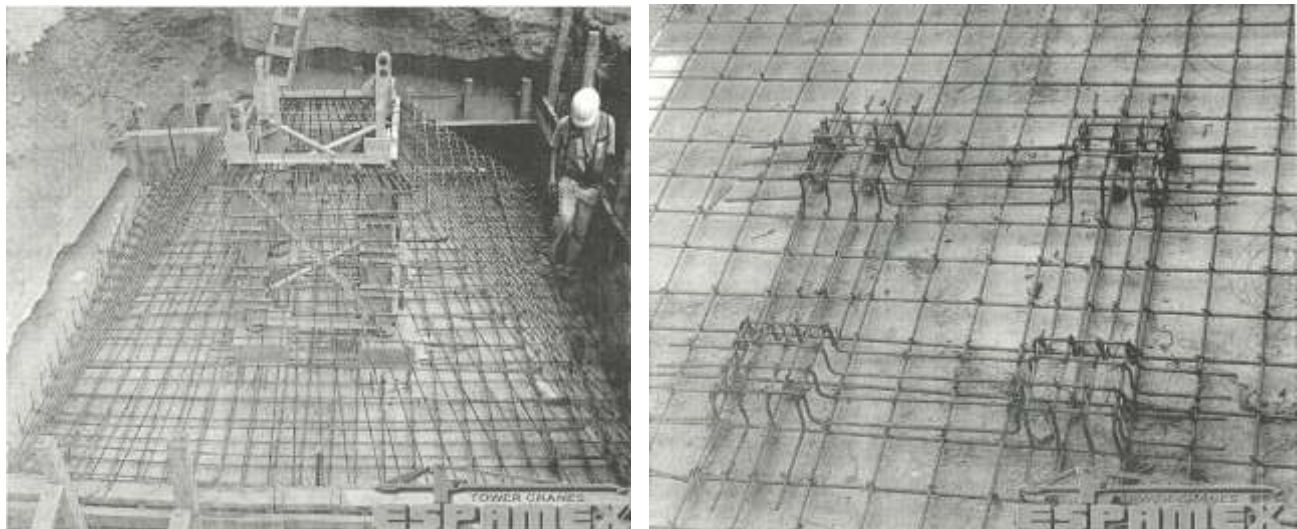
Armado real de las Cimentación de la Grúa Torre
